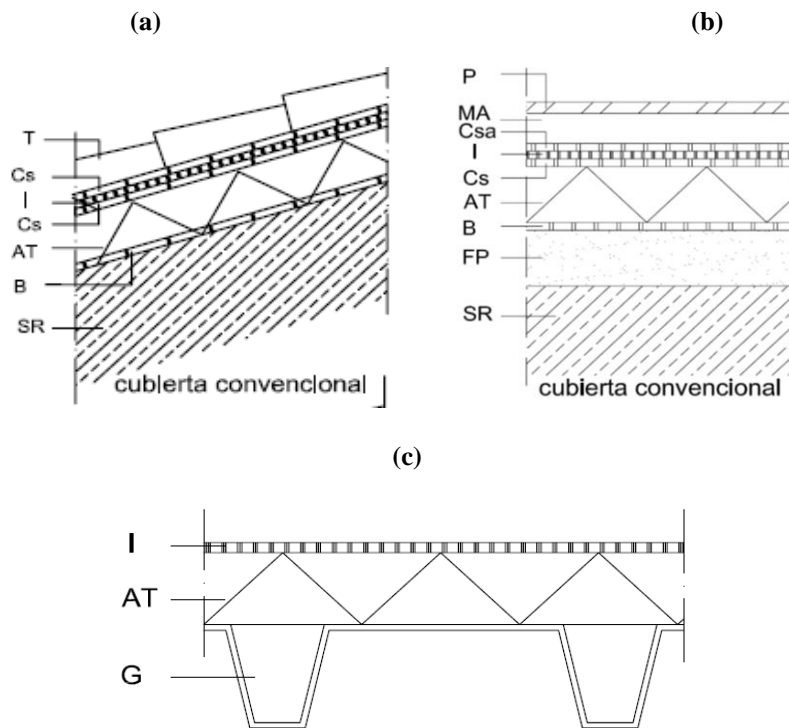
Secciones constructivas de las cubiertas analizadas. Inclineda, forjado inclinado, no ventilada (a). Plana, transitable, no ventilada, solado flotante (b). Plana, no transitable, Autoprotegida (c). Fuente: Catálogo de Elementos Constructivos del CTE [6].
